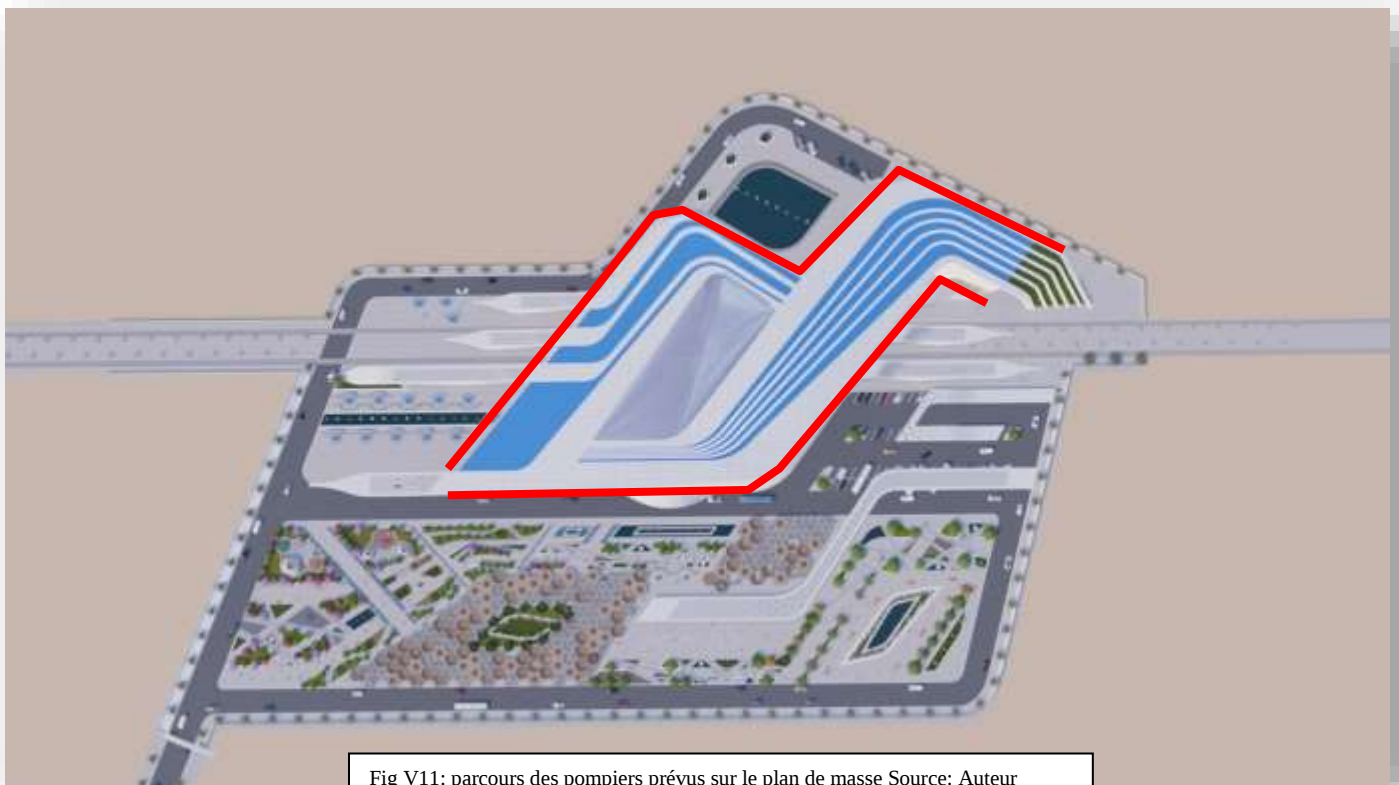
parcours des pompiers prévus sur le plan de masse Source: Auteur
